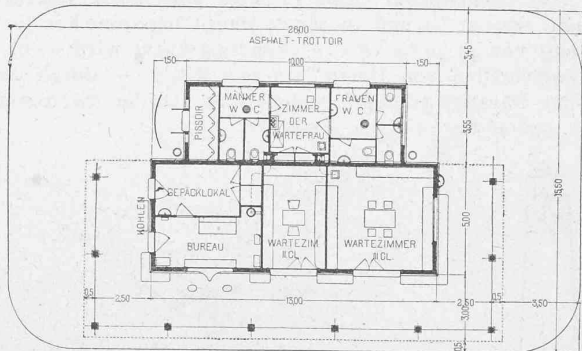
Birsigthalbahn-Station. — Grundriss 1:300.
